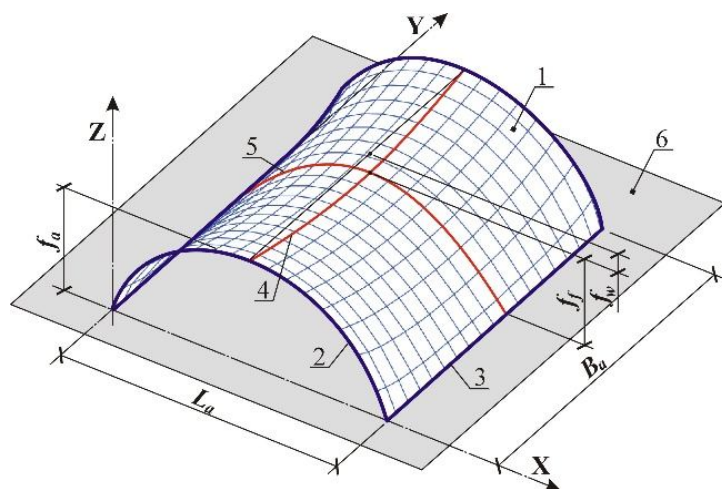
Сектор тентового покрытия арочного типа: 1 – мягкая оболочка; 2 – арка; 3 – балка поперечного направления; 4, 5 – направления «основы» и «утка» мягкой оболочки, соответственно; 6 – базовая плоскость
